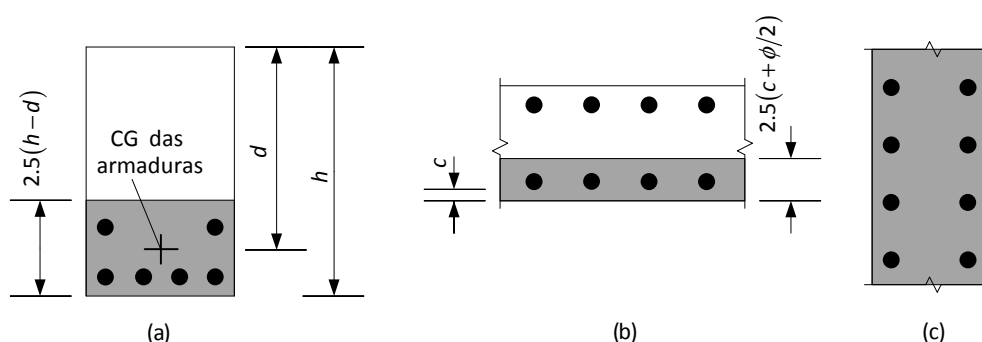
Área efectiva de betão em tracção, (a) viga com secção parcialmente comprimida, (b) laje com secção parcialmente comprimida e (c) elemento com secção transversal toda em tracção.
